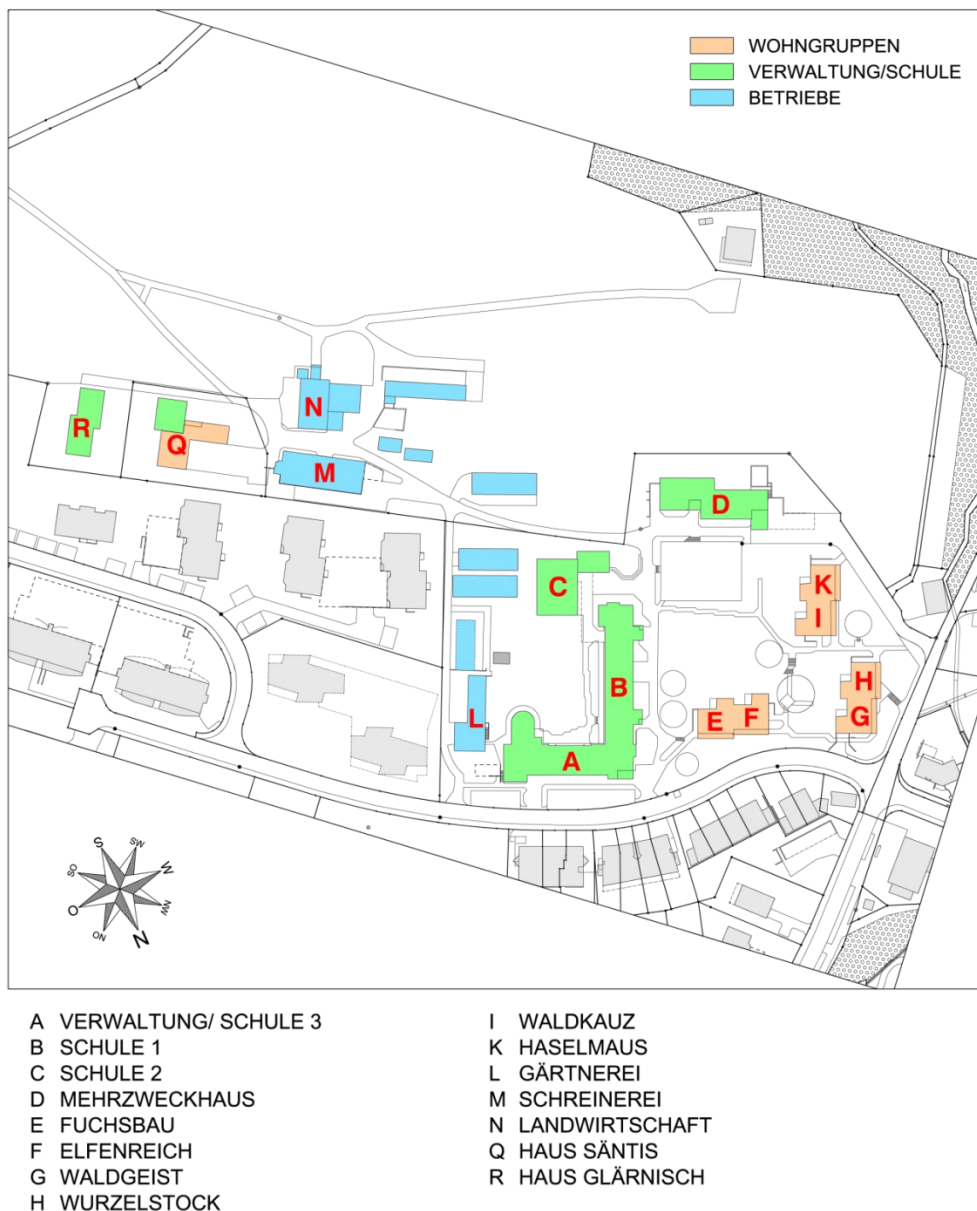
Lageplan der Gebäudeanlage (Stand: Dez.2009).
